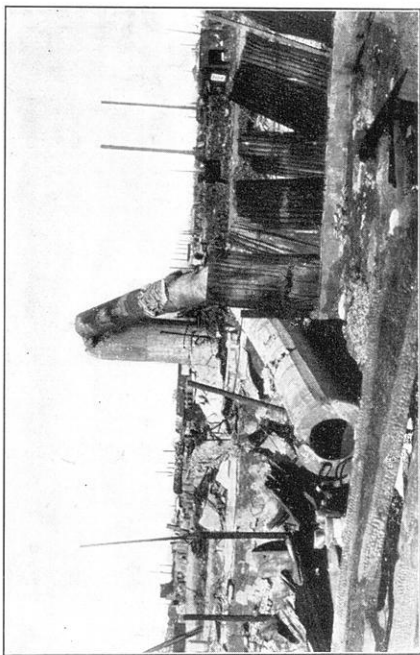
Zerstörung eines Eisenbetonchorrasteins in Yokohama 1923 (Erdbebenperiode 1.35 sec).
